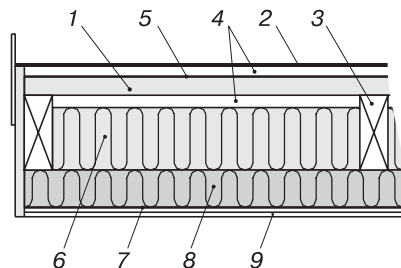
Схема утепления крыши с эксплуатируемым подкровельным пространством. 1 — обрешетка из шпунтованных досок; 2 — оцинкованный лист; 3 — балка; 4 — воздушная прослойка; 5 — гидроизоляция; 6 — теплоизоляция (150 мм); 7 — пароизоляция; 8 — теплоизоляция (50 мм); 9 — два слоя гипсокартона.
